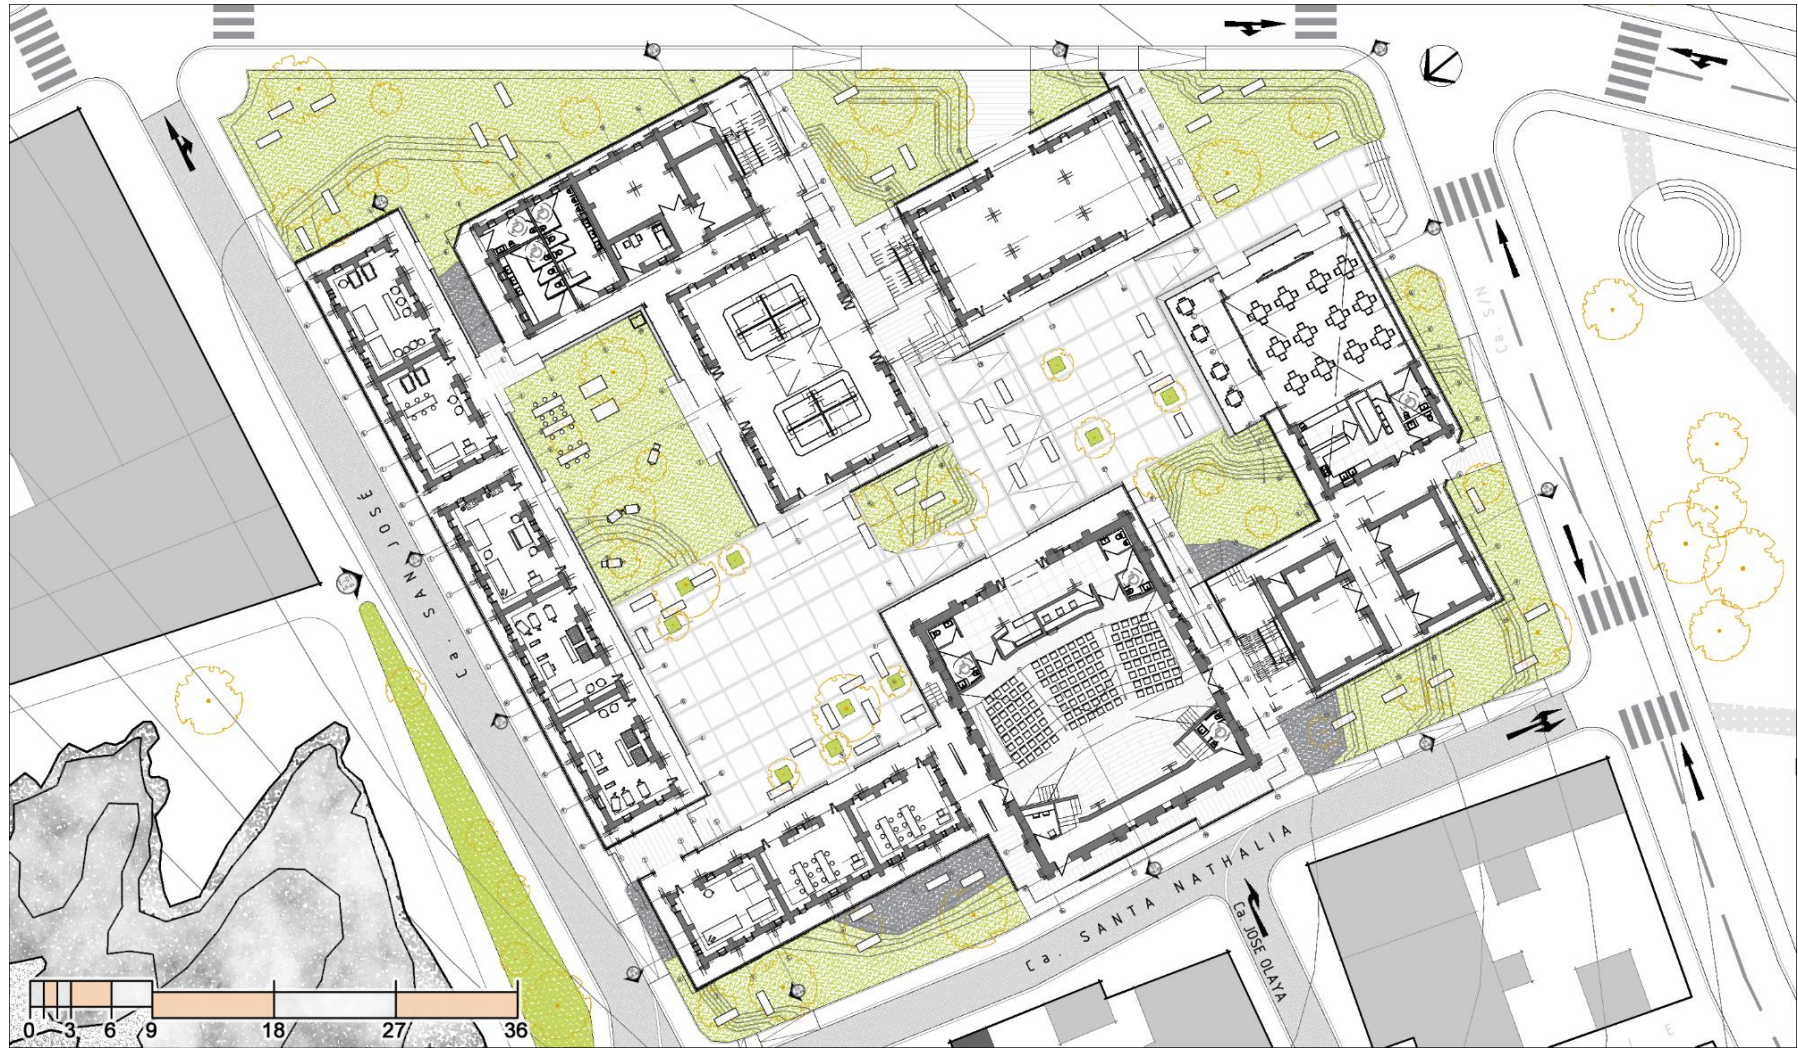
Planta Nivel Primero. Fuente: elaboración propia.
